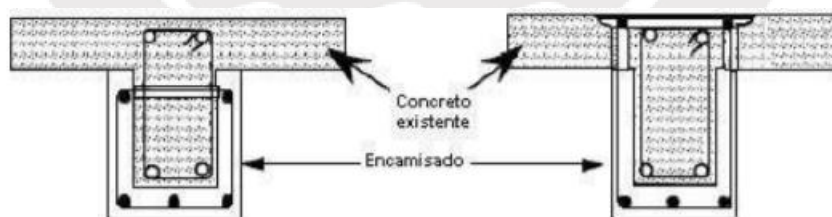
Encamisado de vigas de concreto (Belizario, 2017)
